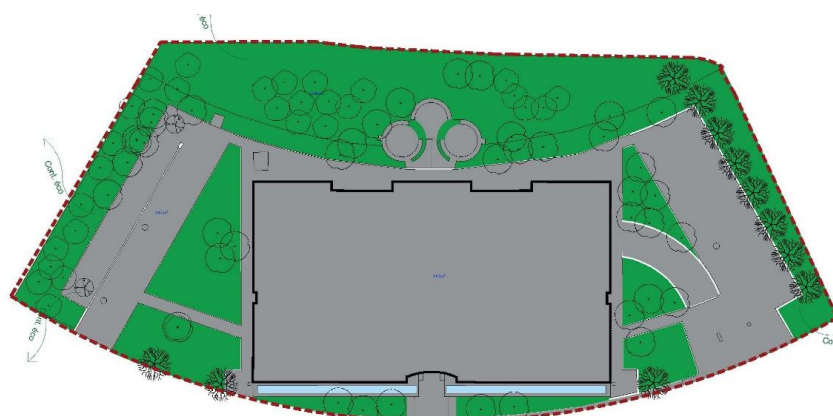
Extrait du plan d'implantation de la situation existante (source : ARTER Architects)
